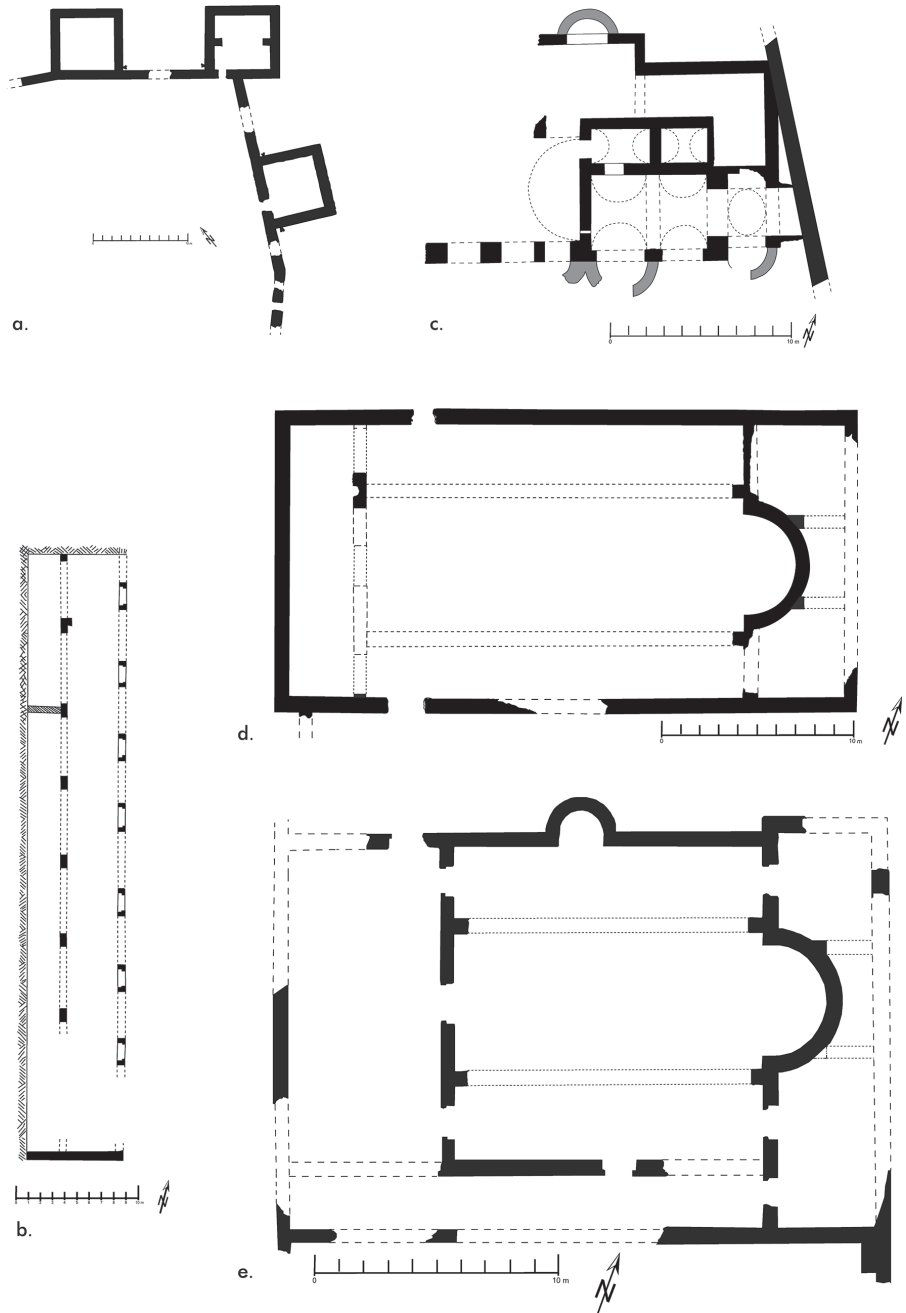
Grundrisse bekannter Bauten: a. Abschnitt der Stadtmauer, b. Hafenspeicher, c. Thermen (?), d. Stadtkirche, e. Friedhofskirche (Abbildungsnachweis: Cubas Díaz nach diversen Angaben und Vorlagen insbesondere von J. Keil – A. Wilhelm).
